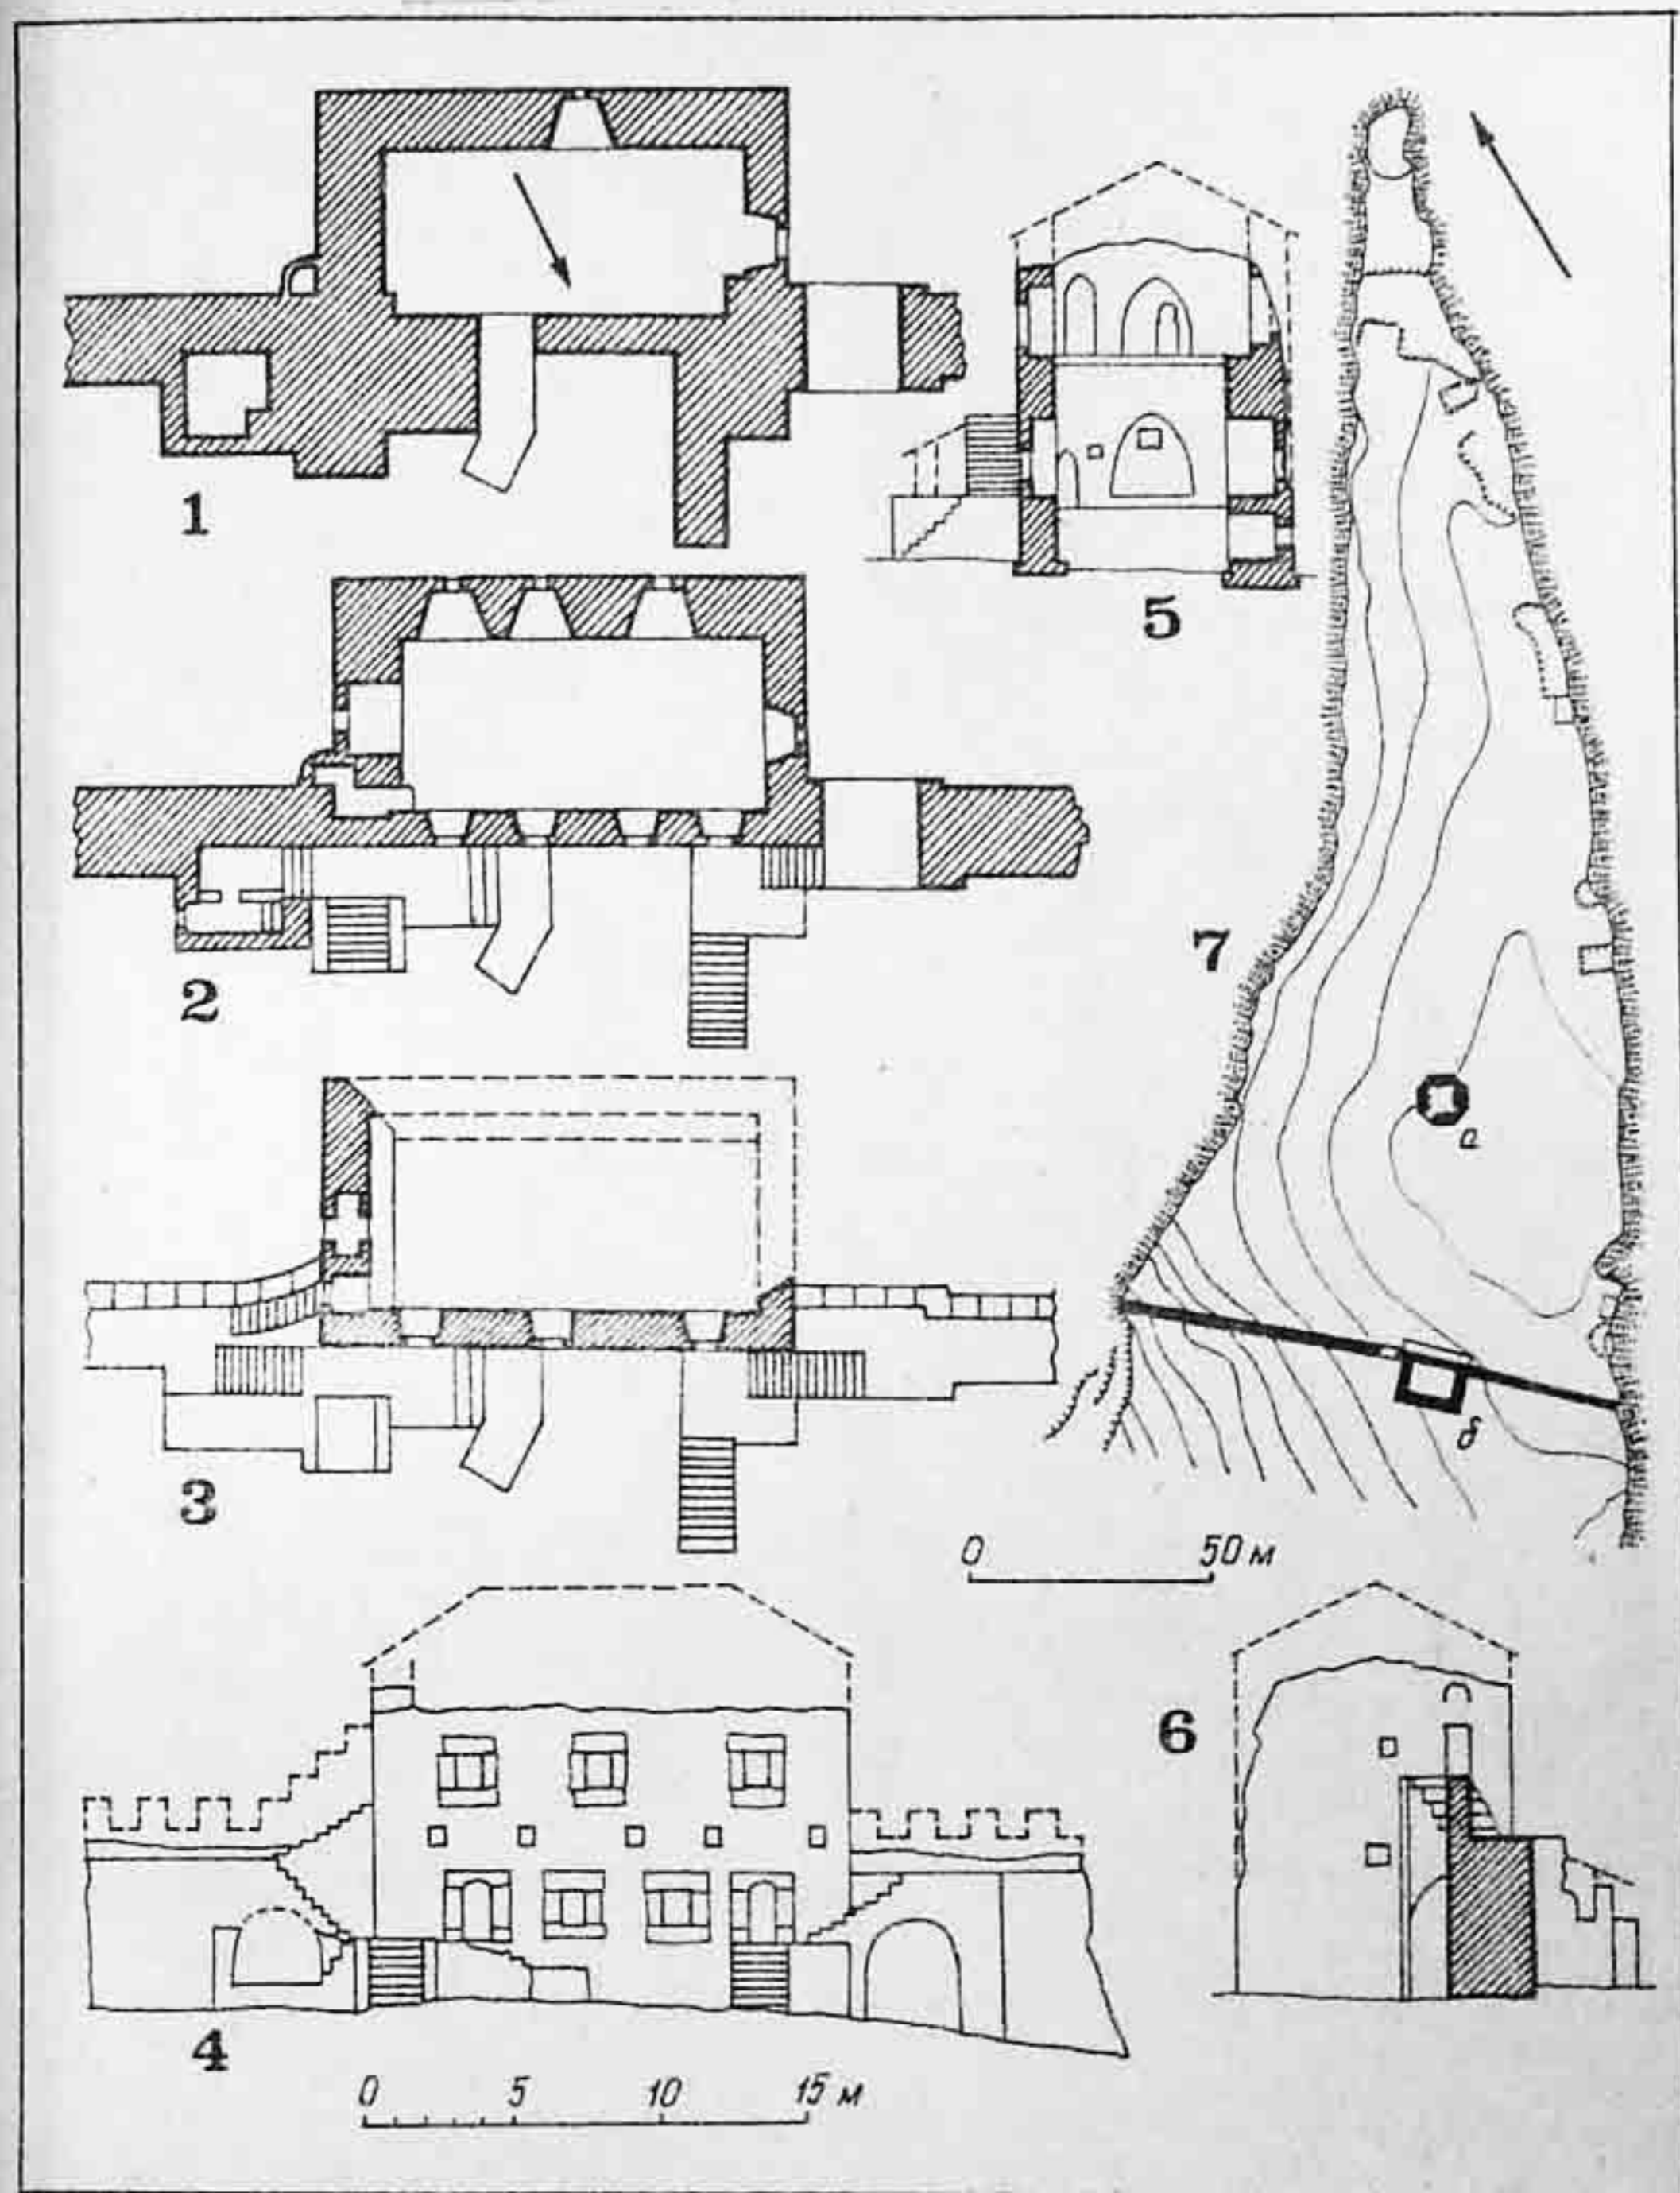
Цитадель Мангула на мысе Тешкли-Бурун (XV в.): 1 — план первого этажа донжона; 2 — план второго этажа; 3 — план третьего этажа; 4 — восточный фасад башни; 5 — поперечный разрез; 6 — южный фасад (по А.Л.Бертье-Делагарду); 7 — план цитадели на мысе Тешкли-Бурун: а — октагональная церковь; б — донжон.
